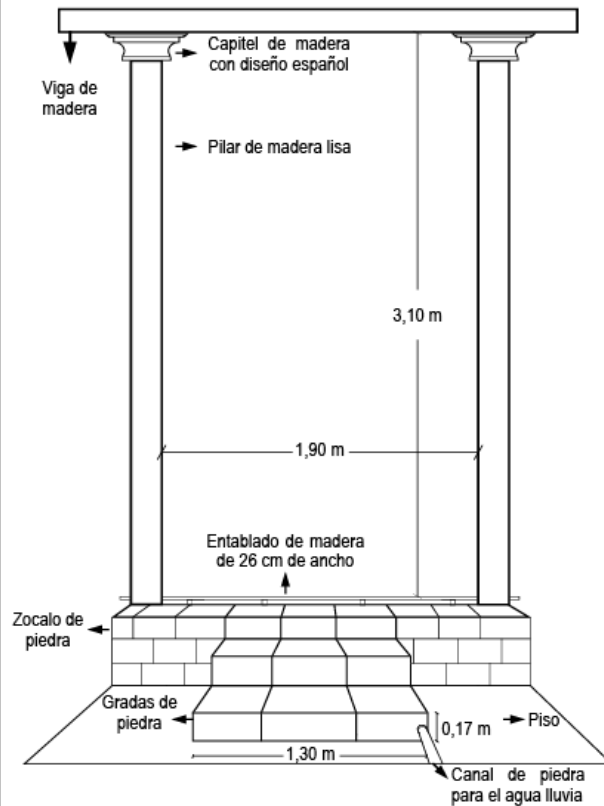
En la ilustración se observa un pórtico con un acceso de gradas en piedra de "tres niveles" muy típico de la época de construcción salvando una altura aproximada de 60 cm con un ancho de 120 cm y terminando el acceso con dos pilares de madera con fuste liso y capitel moldeado, ambos elementos estructurales que soportan una viga de madera donde descansa la estructura de la cubierta. Al inicio de las gradas de piedra se observa un canal para el agua lluvia que sirve para desembocar el líquido hacia el patio y no afectar la integridad de la madera con la humedad y la misma agua.
